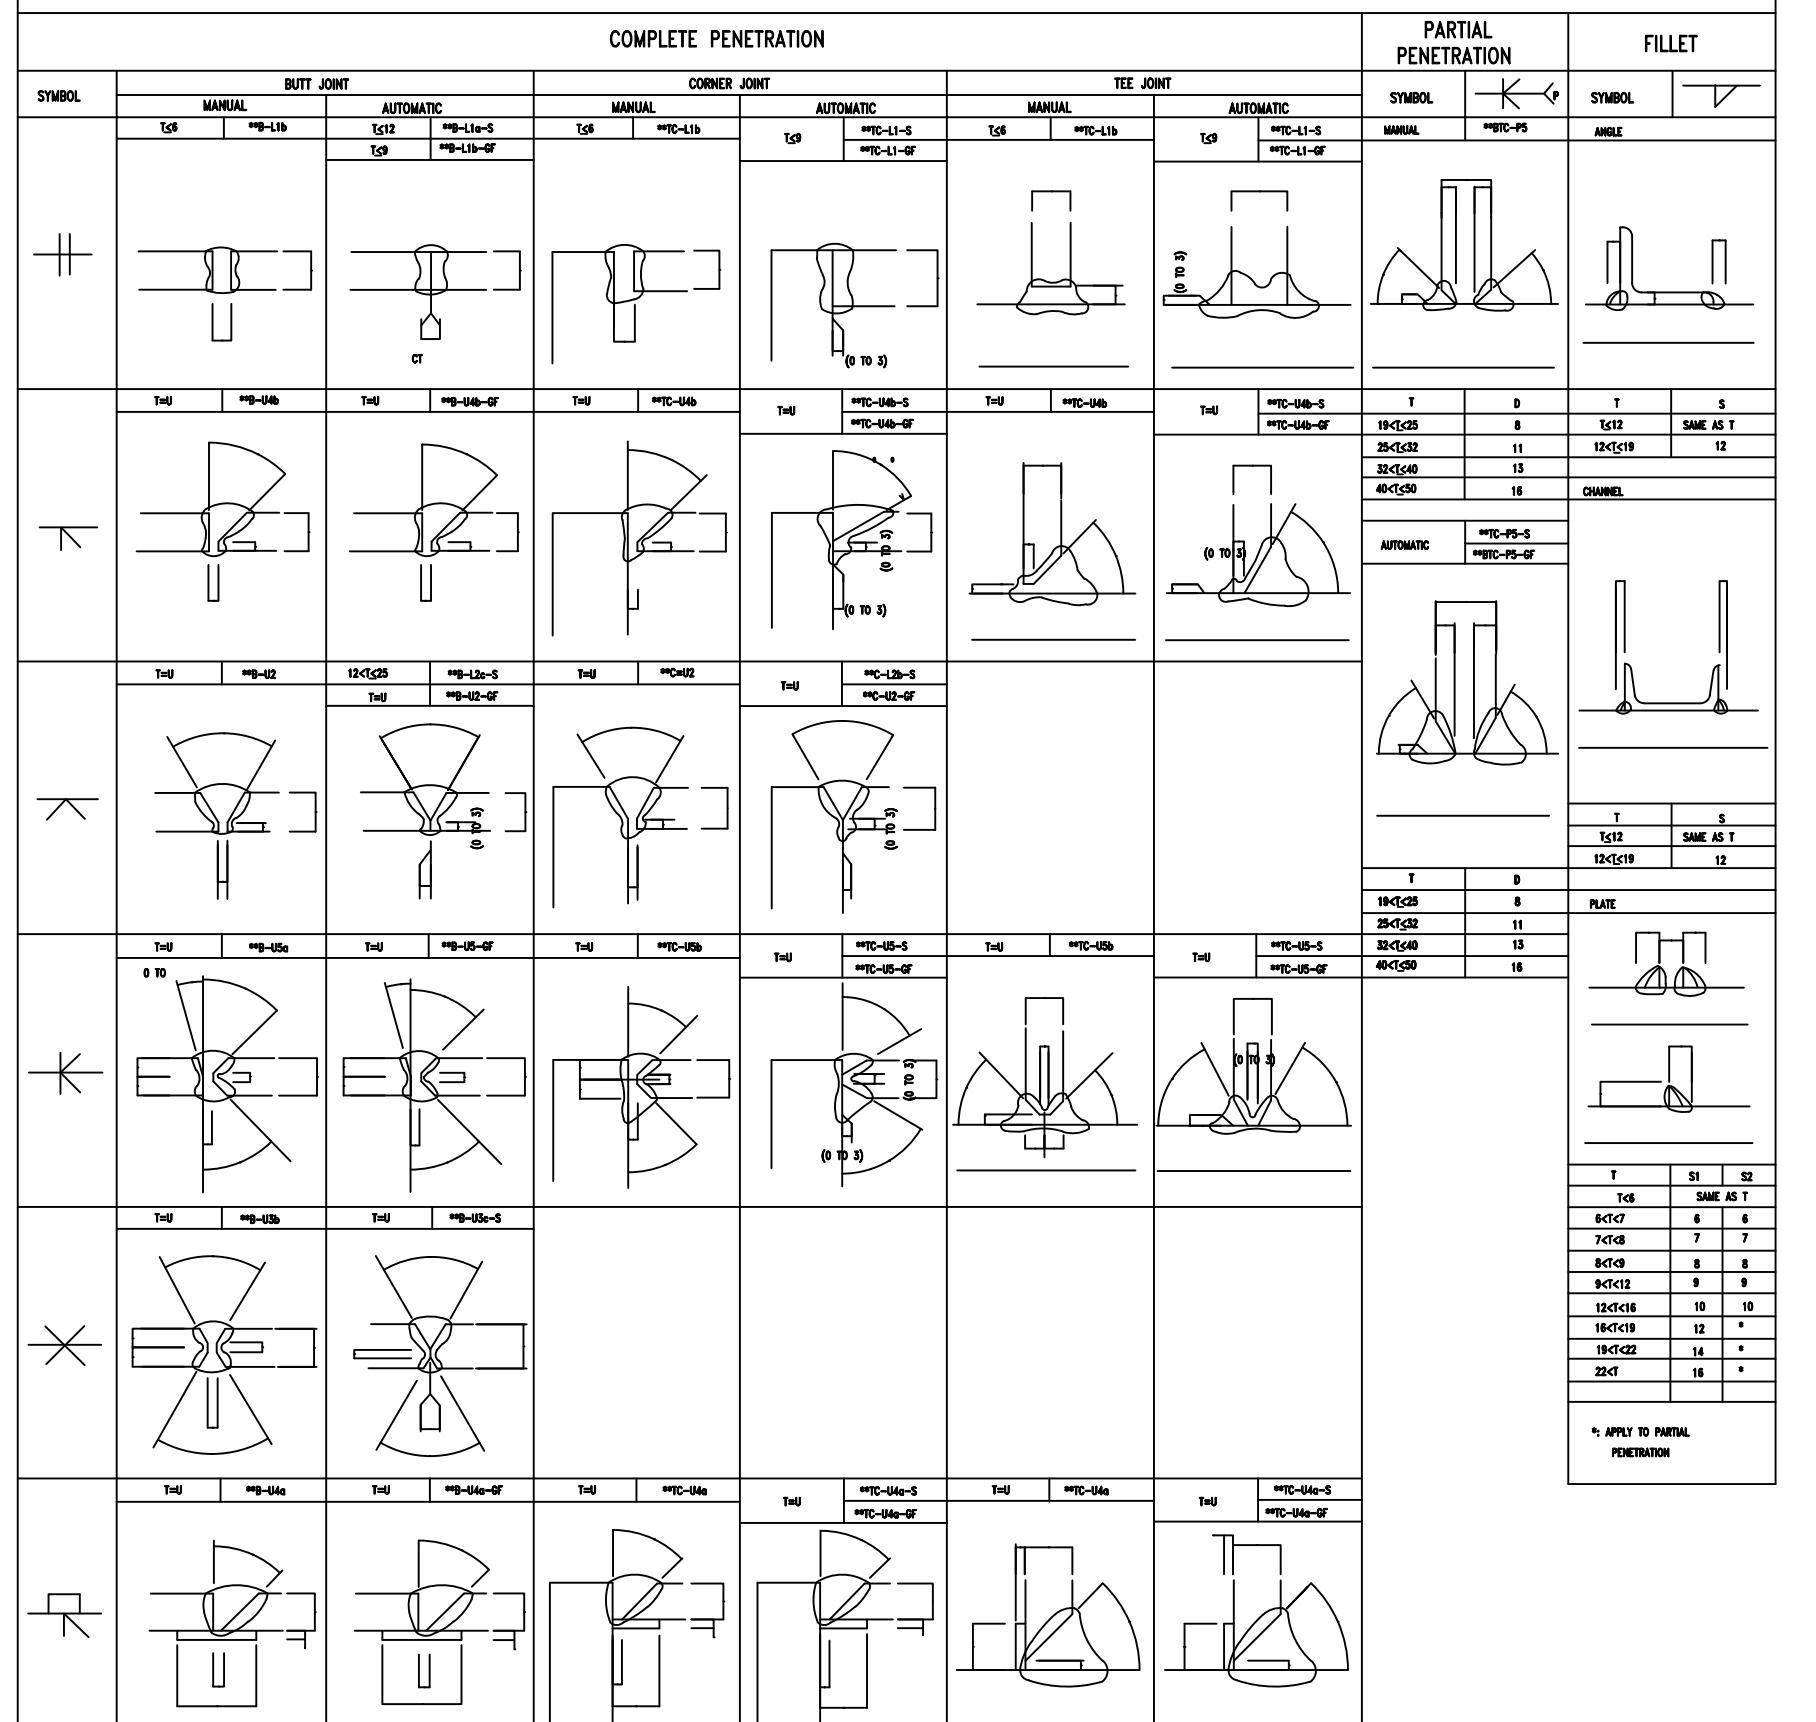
# DETAIL STANDAR UNTUK PEKERJAAN STRUKTUR BAJA (1)
